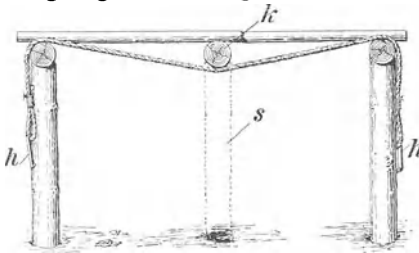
Schalholz-zimmerung mit Drahtseilen.
